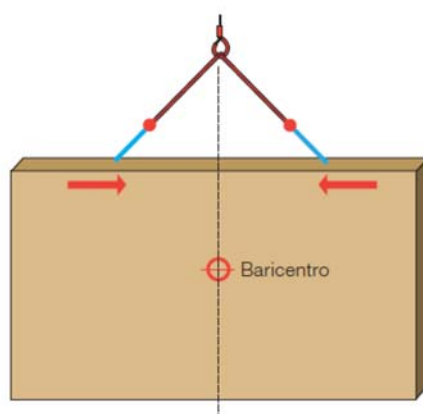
Rischio di inflessione della traversa superiore in seguito a compressione
